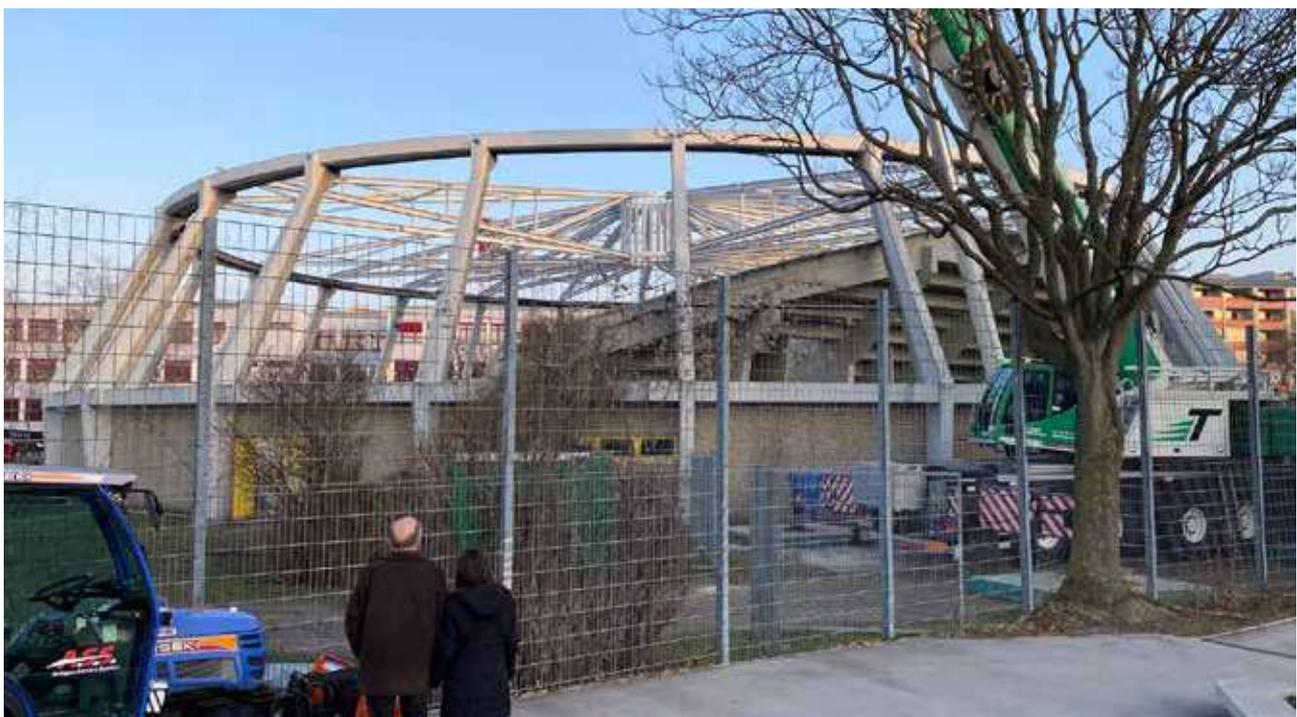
Sanierung der Rundsporthalle in Kagran, neue Dachkonstruktion
